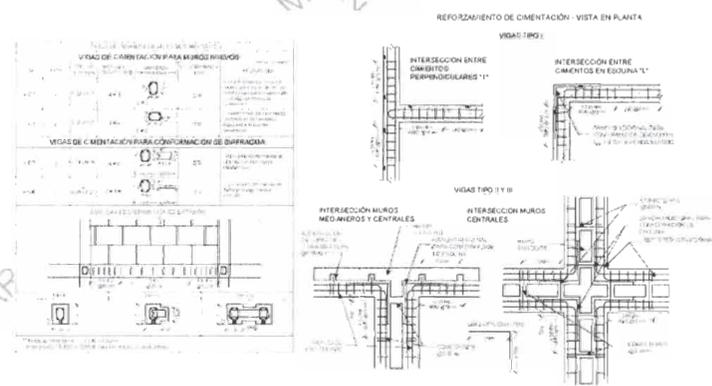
Nueva viga de cimentación en concreto reforzado para muros perimetrales sobre concreto ciclópeo existente.
